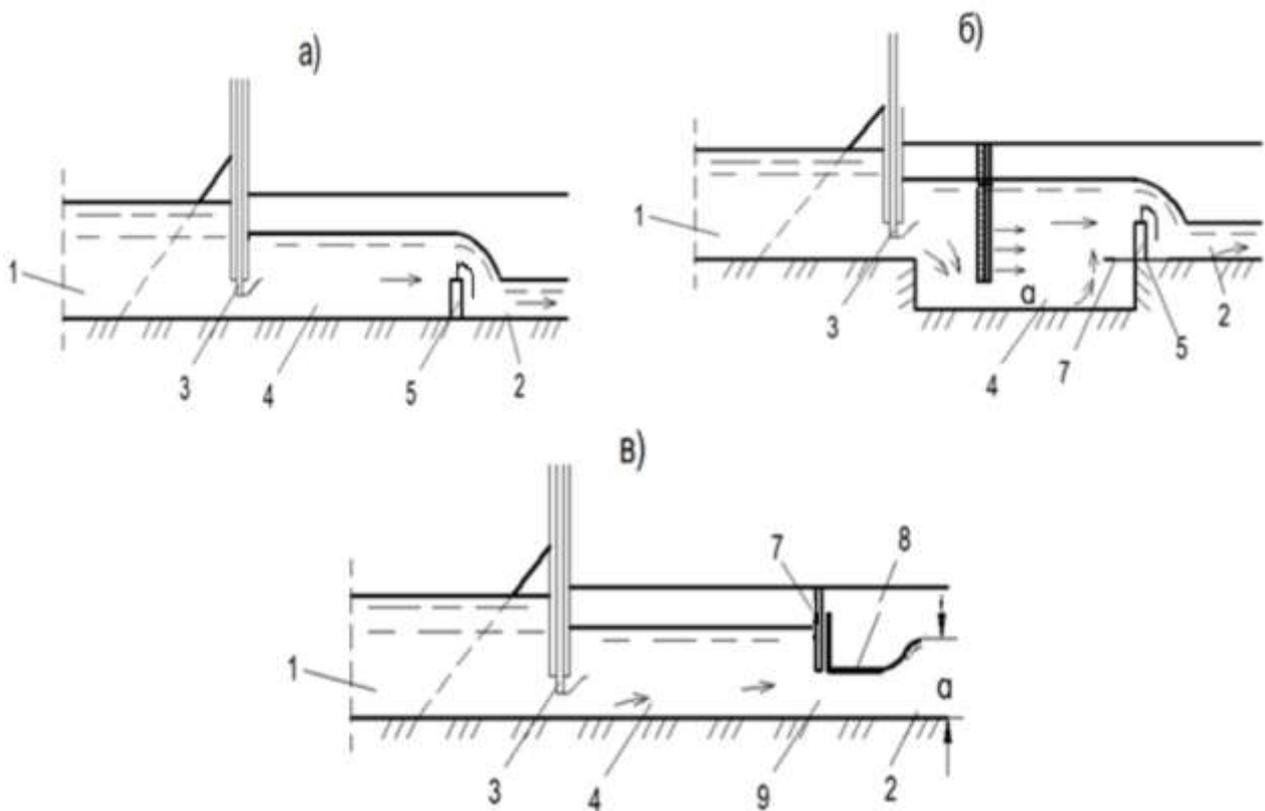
Схемы водомеров с колодцами-гасителями – продольные разрезы. а, в – колодцы-гасители с неуглубленными днами; б – то же с углубленным дном. а, б – водомеры типа «Водослив с тонкой стенкой»; в – водомер типа «Прямоугольный насадок».
